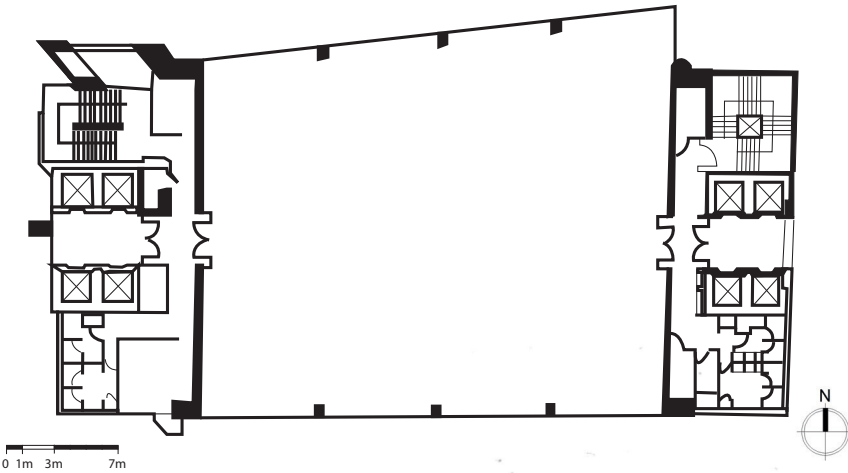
Planta tipo piso 24 al 33 . Fuente de: Elaboración propia.
